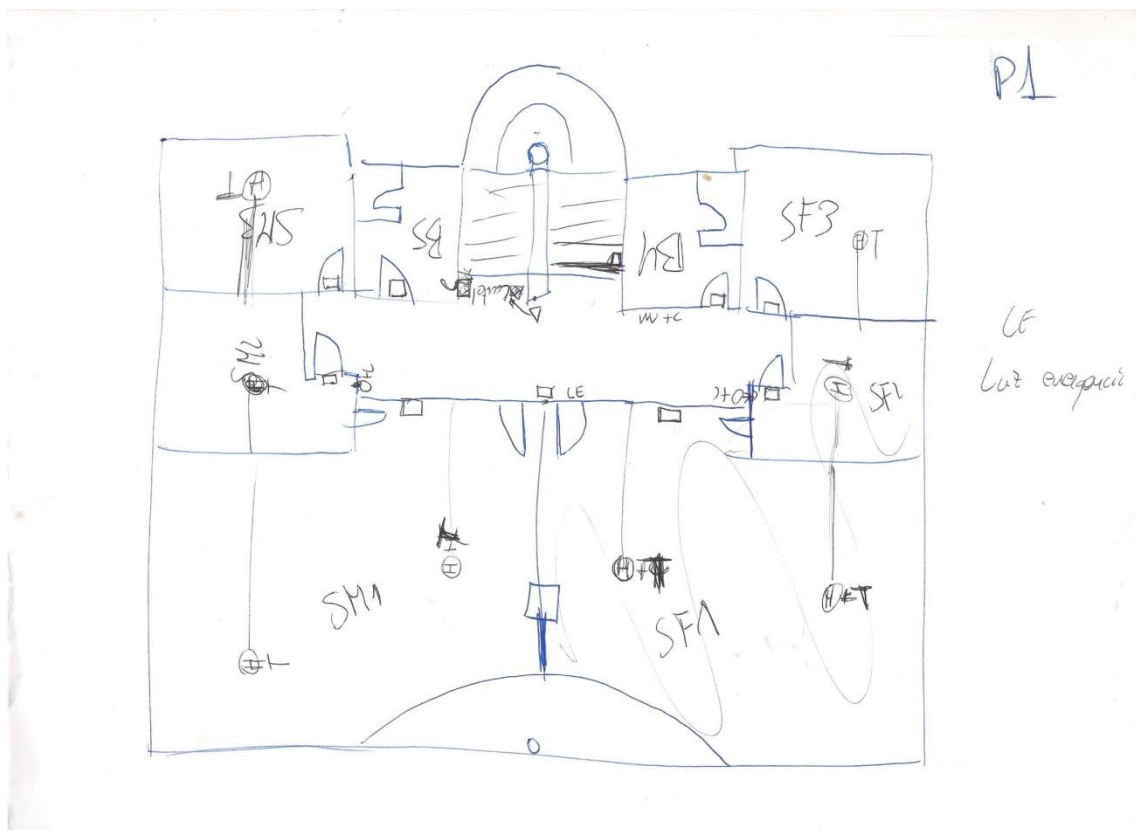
Croquis de la primera planta con los equipos de la instalación contra incendio del edificio. Fuente: Elaboración propia.
